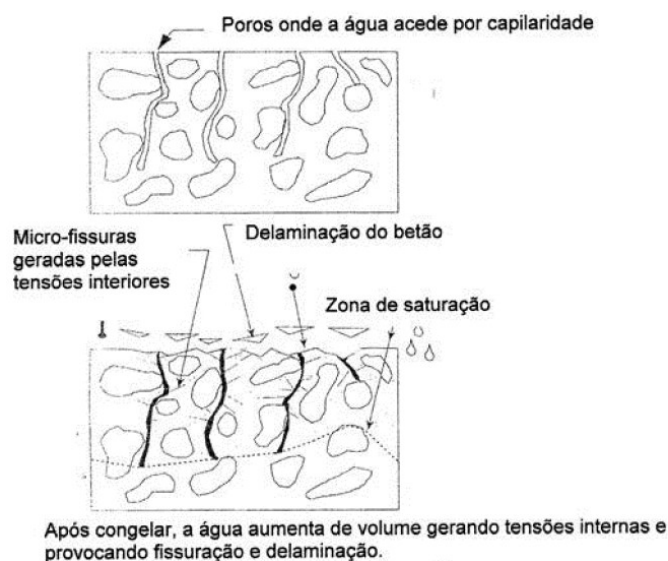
Processo de fissuração por solidificação da água capilar [5]
